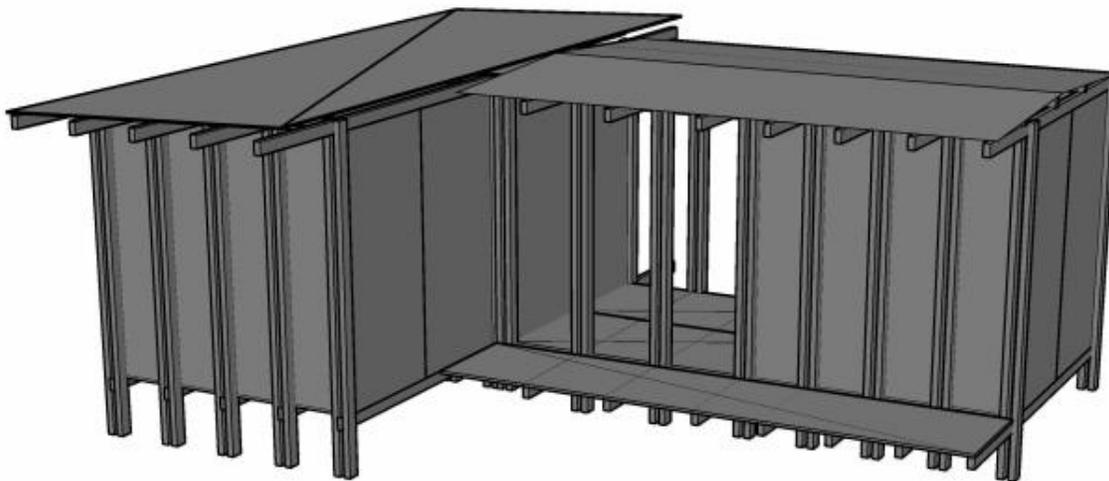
Modelo alternativo de vivienda prefabricada. Fuente: TECHO.
